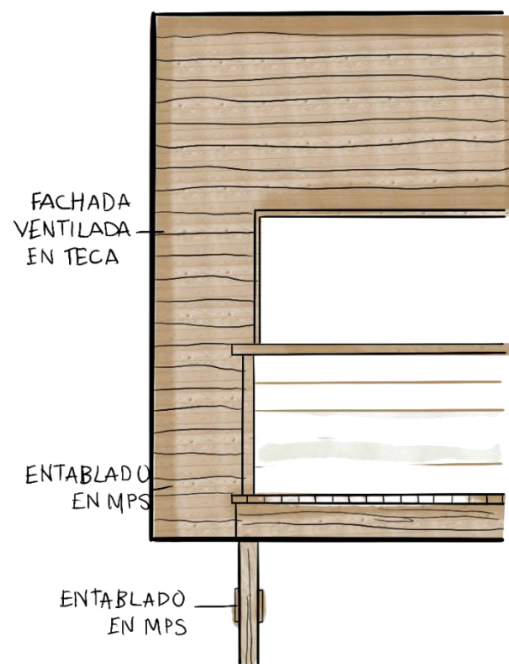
Detalle constructivo de la fachada con base a la información extraída anteriormente- Autoría propia
